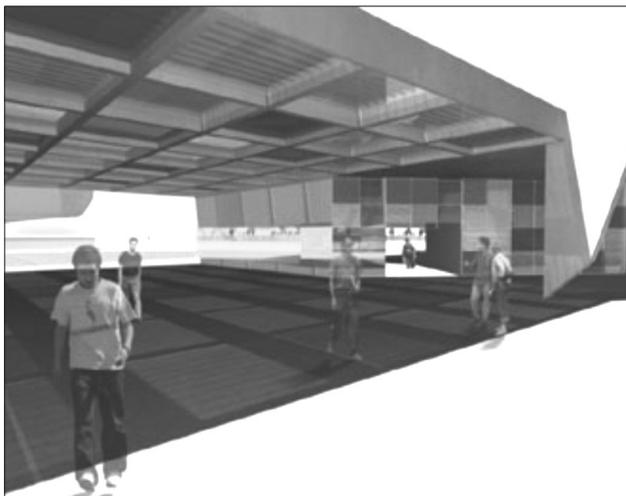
Gilfranco Alves e equipe – Maquete eletrônica.
